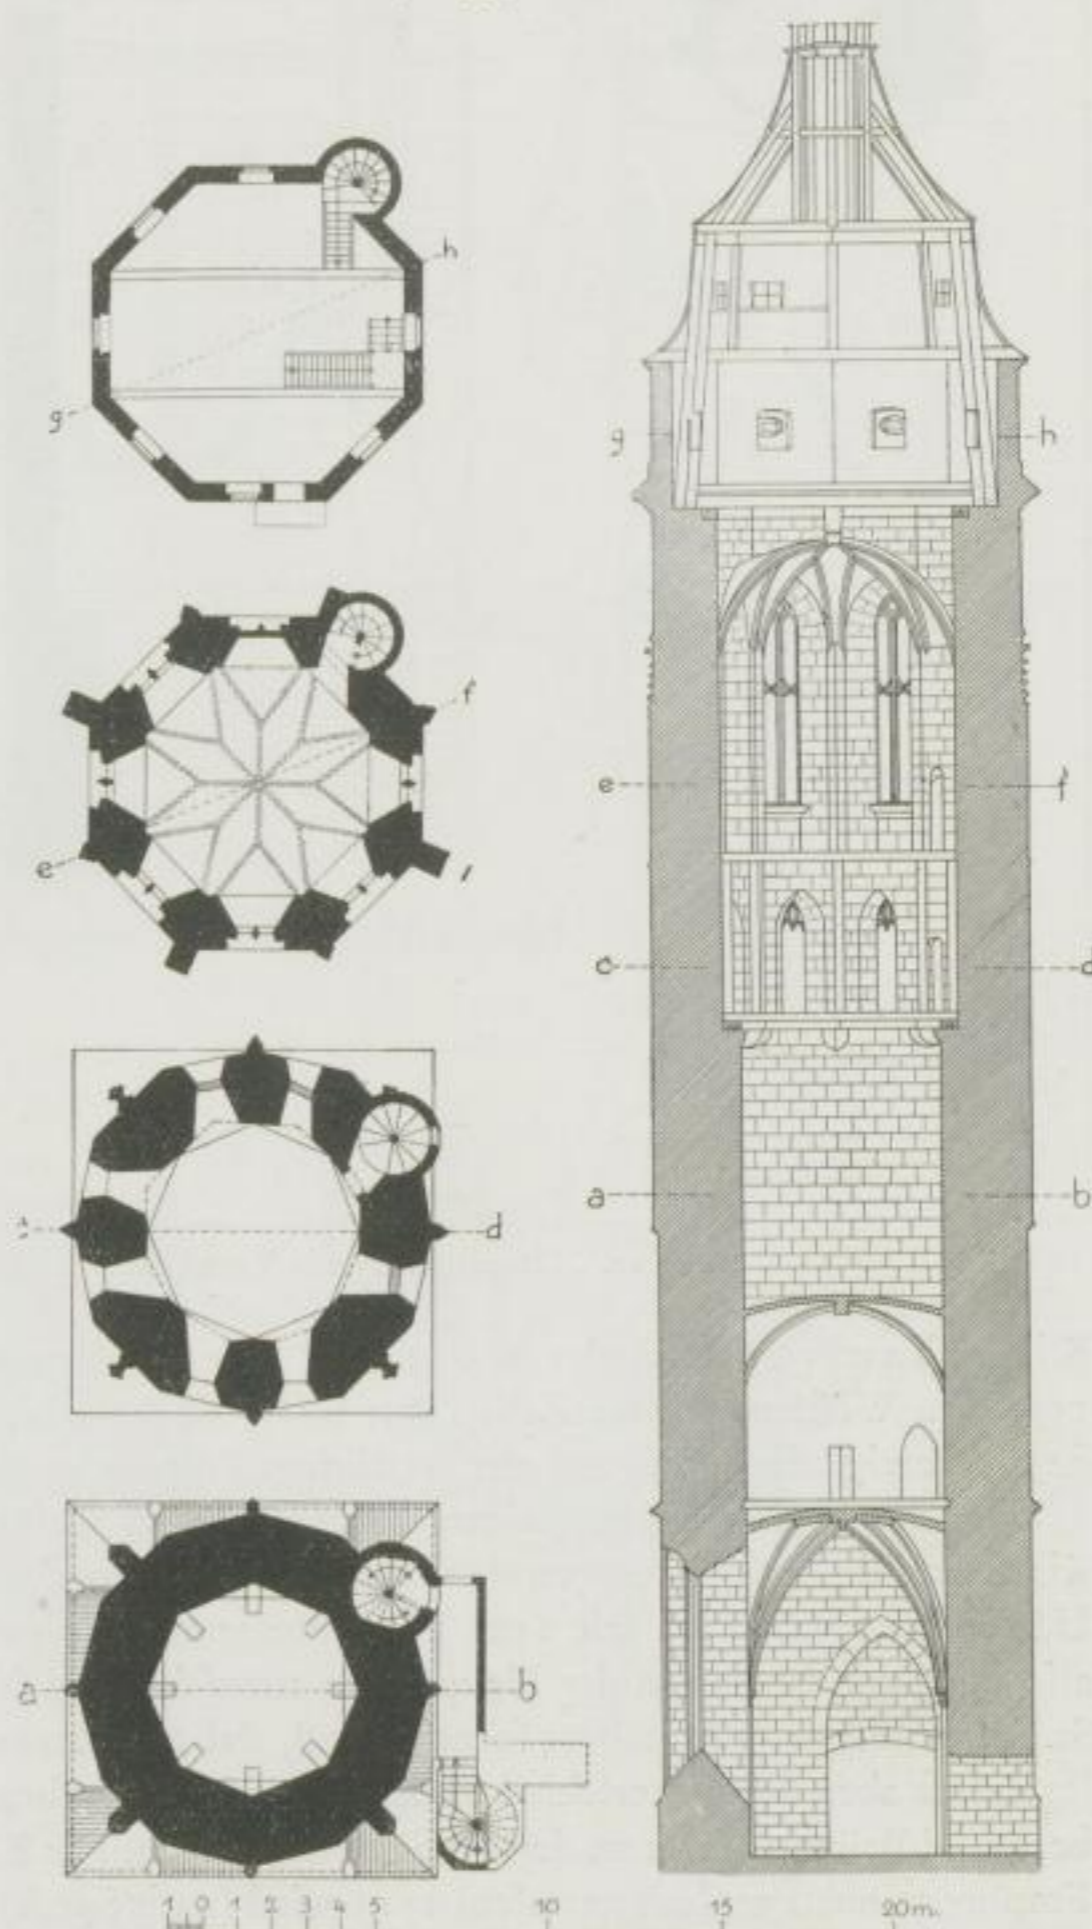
Schnitt West-Ost durch den Turm der Stadtkirche mit den Grundrissen in verschiedener Höhe
